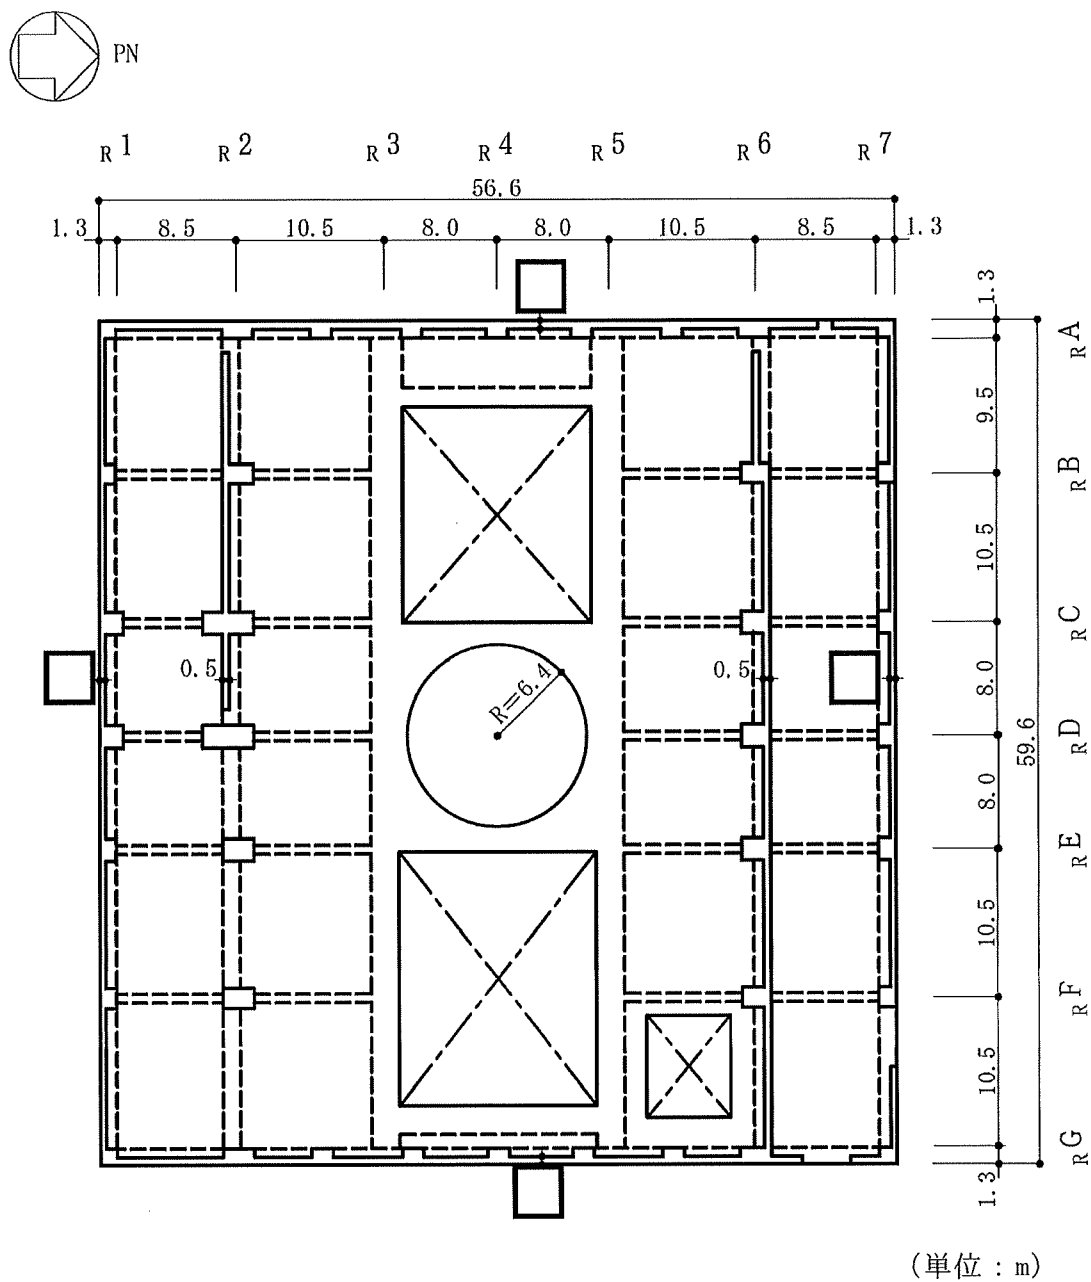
原子炉建屋の概略平面図 (4F, T.M.S.L. 31.7m) (7/9)
